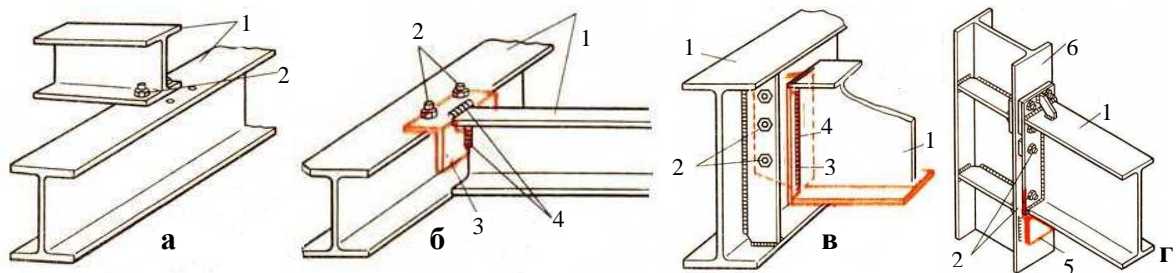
Болтові з'єднання сталевих конструкцій: а – під час поверхового обпирання балок; б, в – на опорних кутках; г – із оперттям на планку; 1 – балки; 2 – болти; 3 – опорний кут; 4 – зварний шов, що з'єднує опорний кут і балку; 5 – опорна планка; 6 – колона
